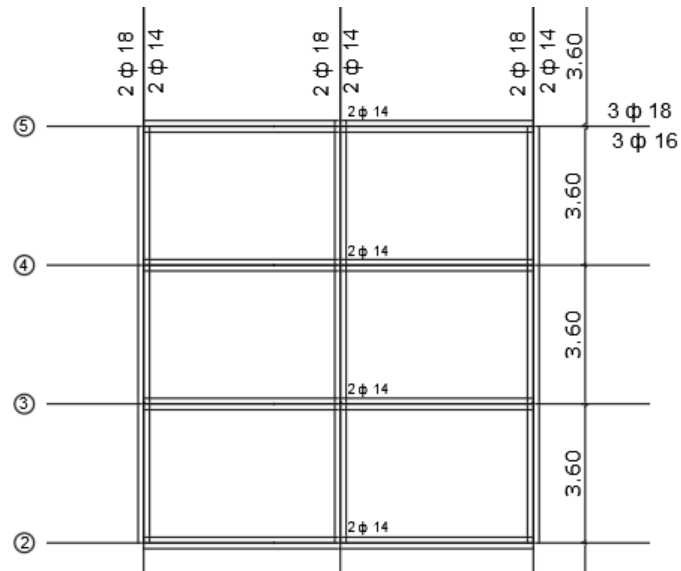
Esquema de Armado cubierta; Fuente: Autoría Propia
